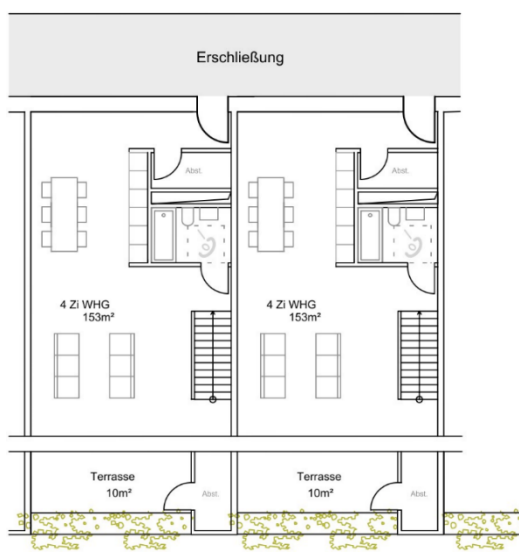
| Quartier 06: Beispielgrundriss Maisonette (unten)
